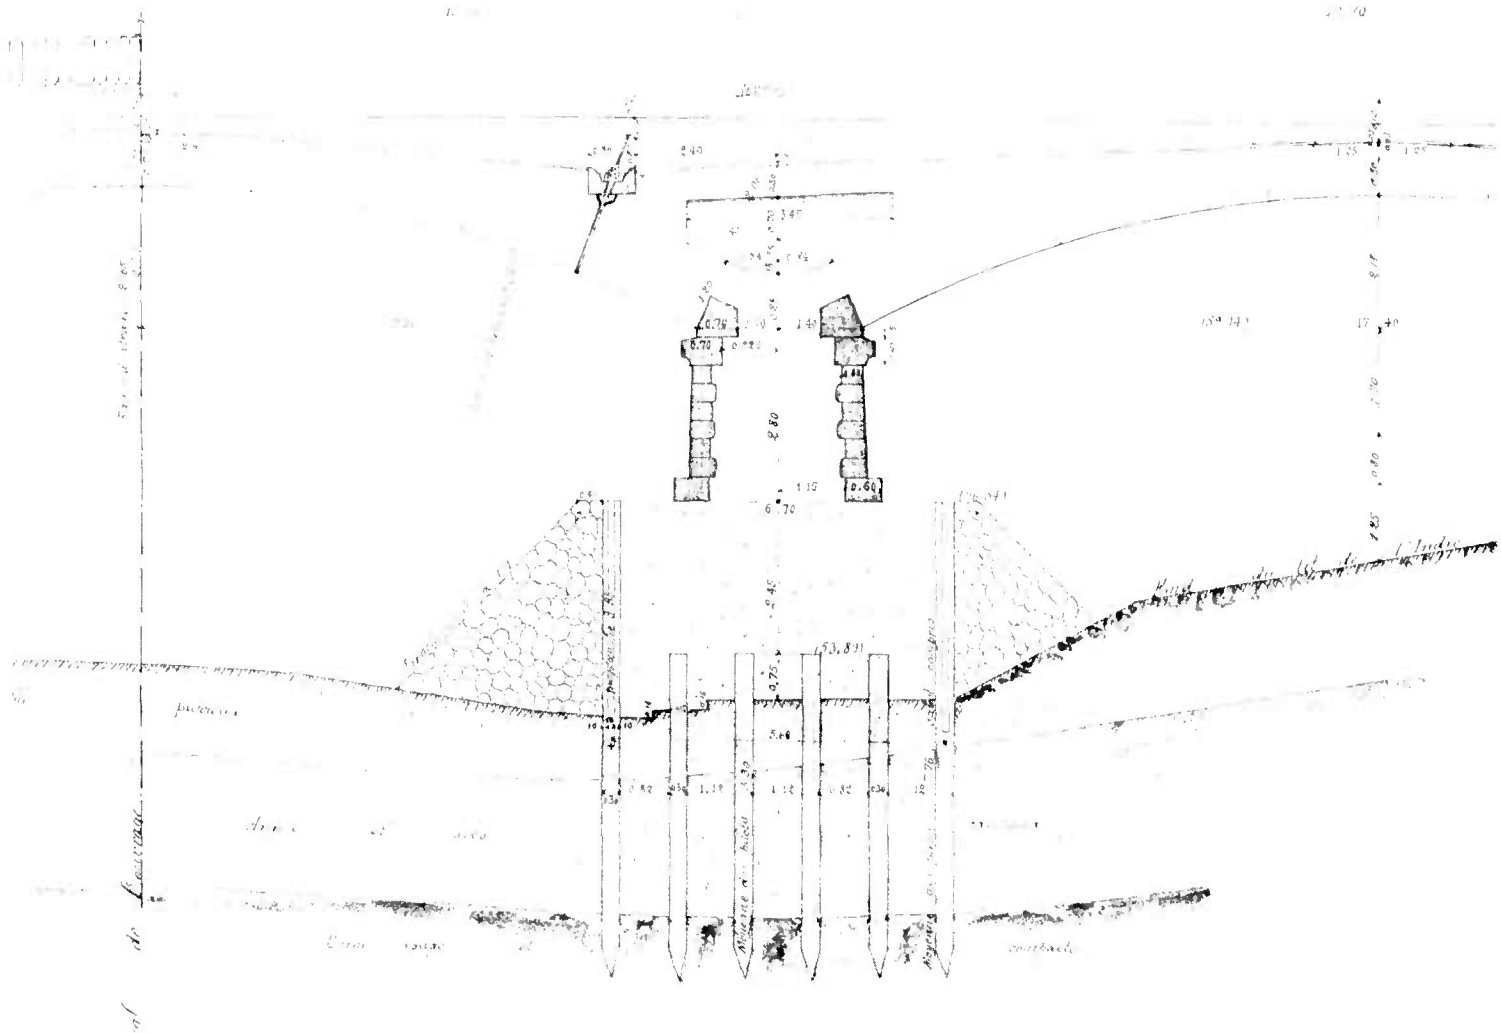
Fondation sur pieux avec suppression du grillage et béton coulé dans une enceinte en palplanches (milieu du XIX<sup>e</sup> siècle)
